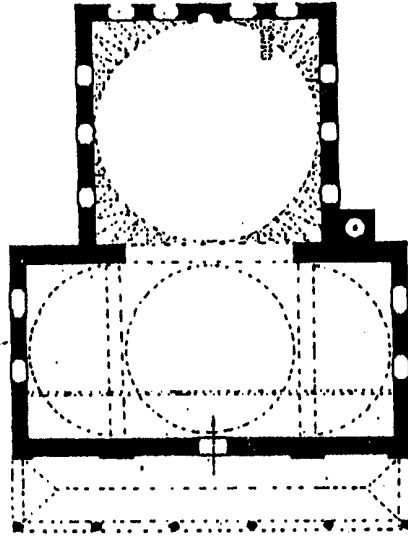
مسقط أفقي لجامع الدرويشية بدمشق (عن : Sauvaget)
